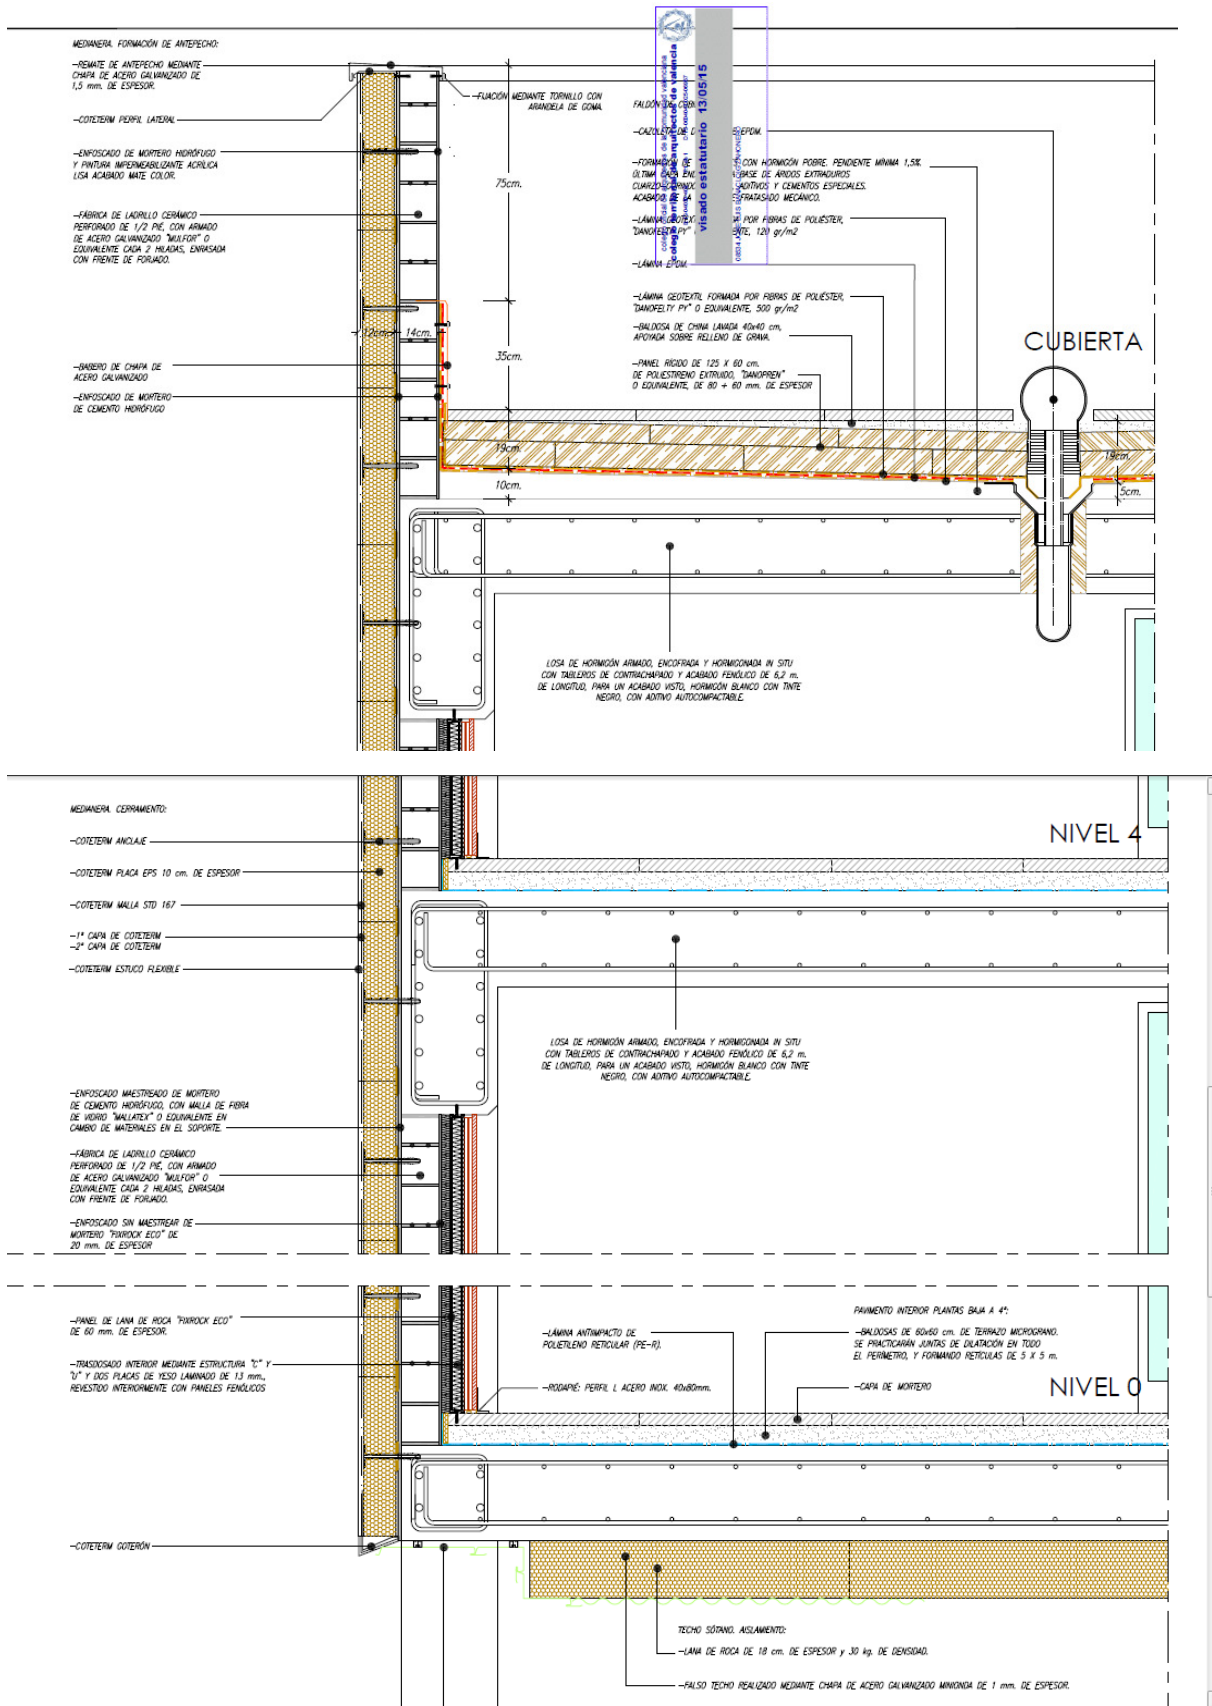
Detalle de fachada: Sección vertical por fachada Oeste (Medianera). Plano 1.26. Proyecto Modificado. de Ejecución de Edificio de Institutos de Investigación. Abril 201. Arquitecto José Luis Banacloig Zahonero.
